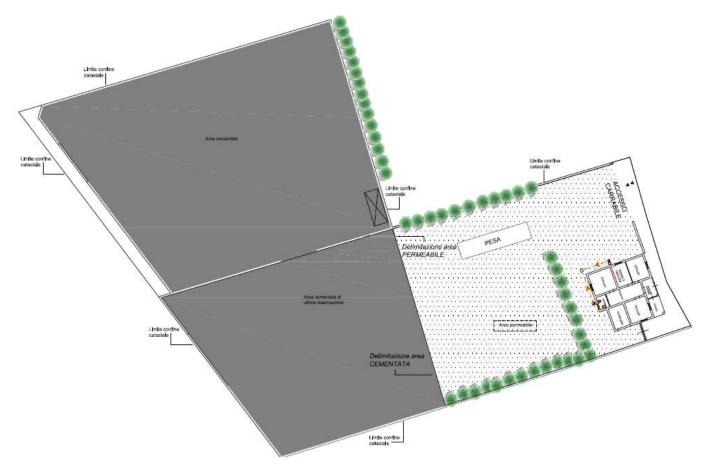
planimetria con l'indicazione delle aree pavimentate estratta dalla TAV.0 – Opere Approvate
